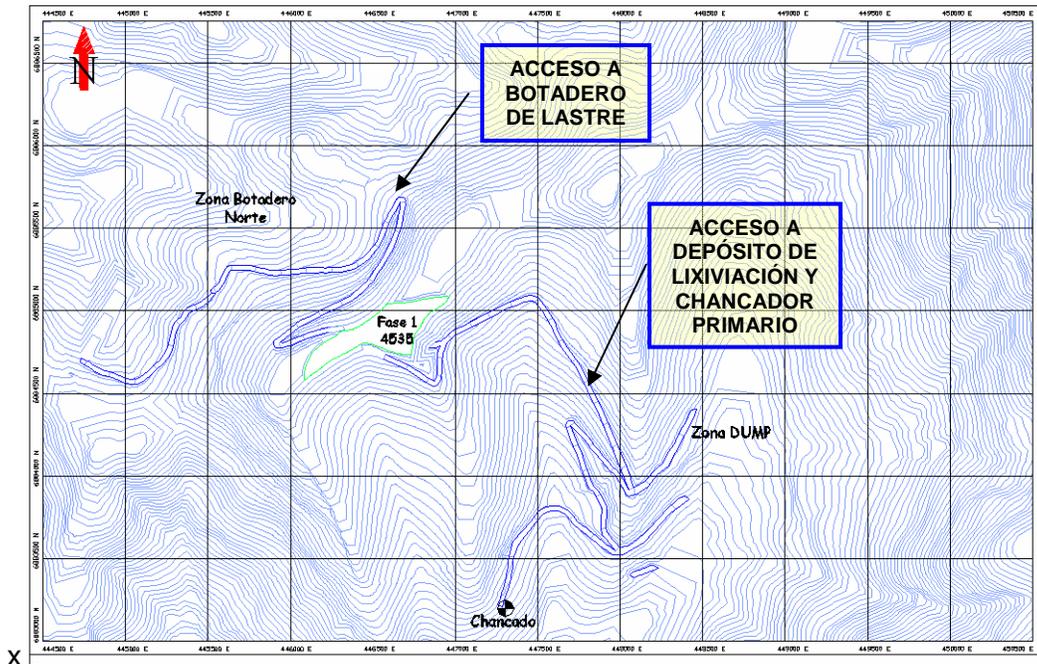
Accesos a Botadero de Lastre y Lixiviación.
